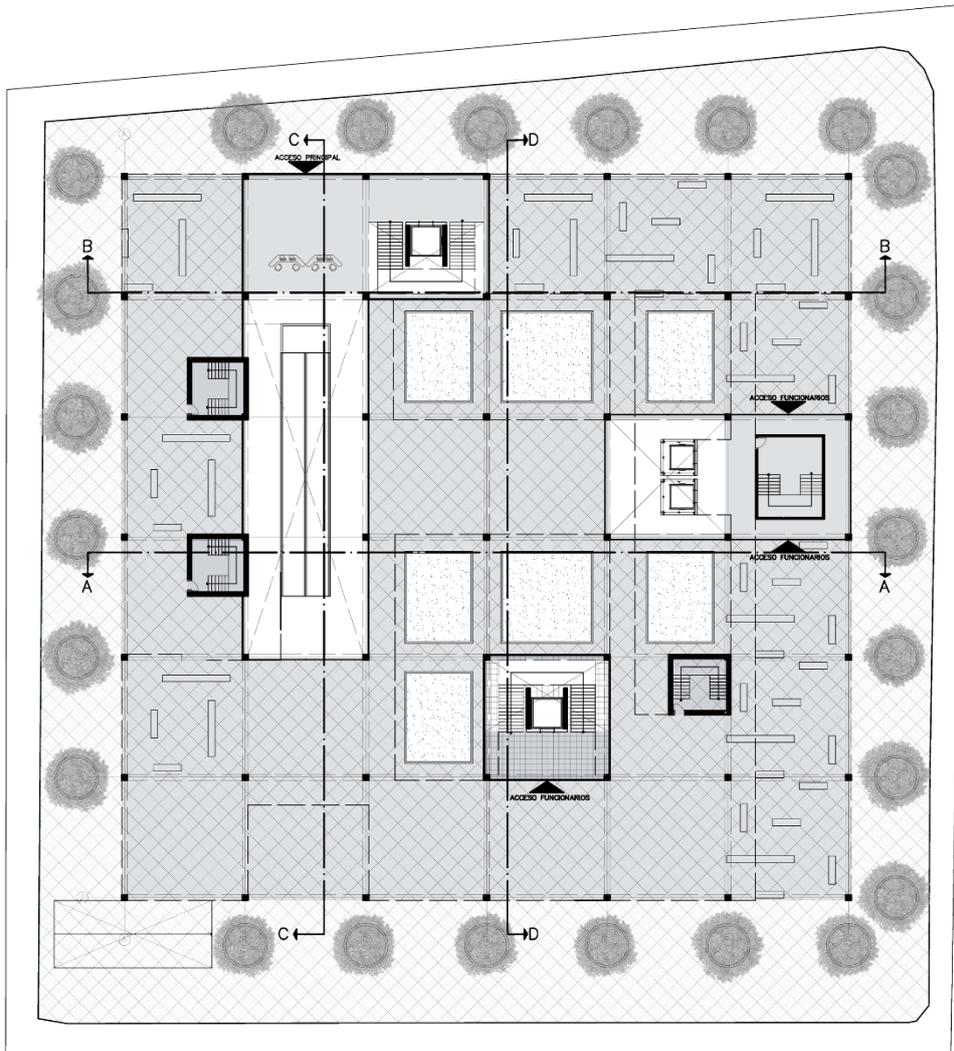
PLANTA BAJA. ESCALA VARIADA
